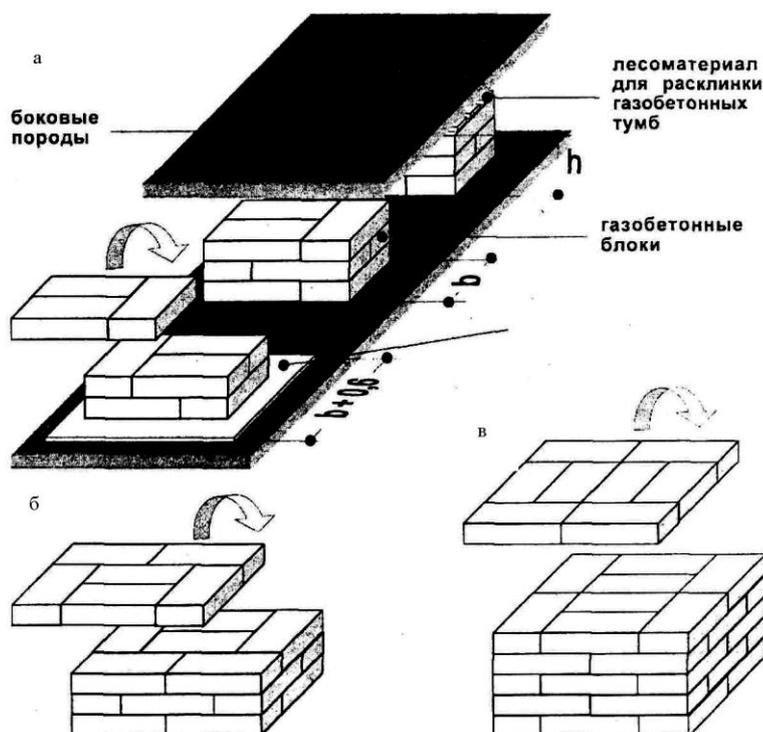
Способы укладки и перевязки газобетонных блоков при возведении охранных крепежных конструкций в виде сборных тумб: а – варианты укладки газобетонных блоков и расположение тумб вдоль охраняемой выработки при размерах крепежных конструкций в плане  $0,6 \times 0,9$  м; б – варианты укладки блоков при размерах газобетонной тумбы в плане  $0,9 \times 1,2$  м; в – варианты укладки блоков при размерах газобетонной тумбы в плане  $1,2 \times 1,2$  м
